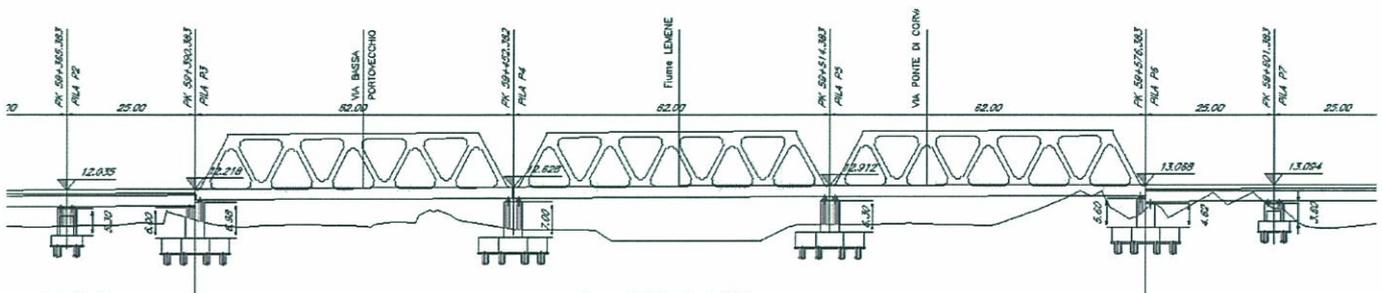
Prospetto in corrispondenza dell'attraversamento del fiume Lemene.
